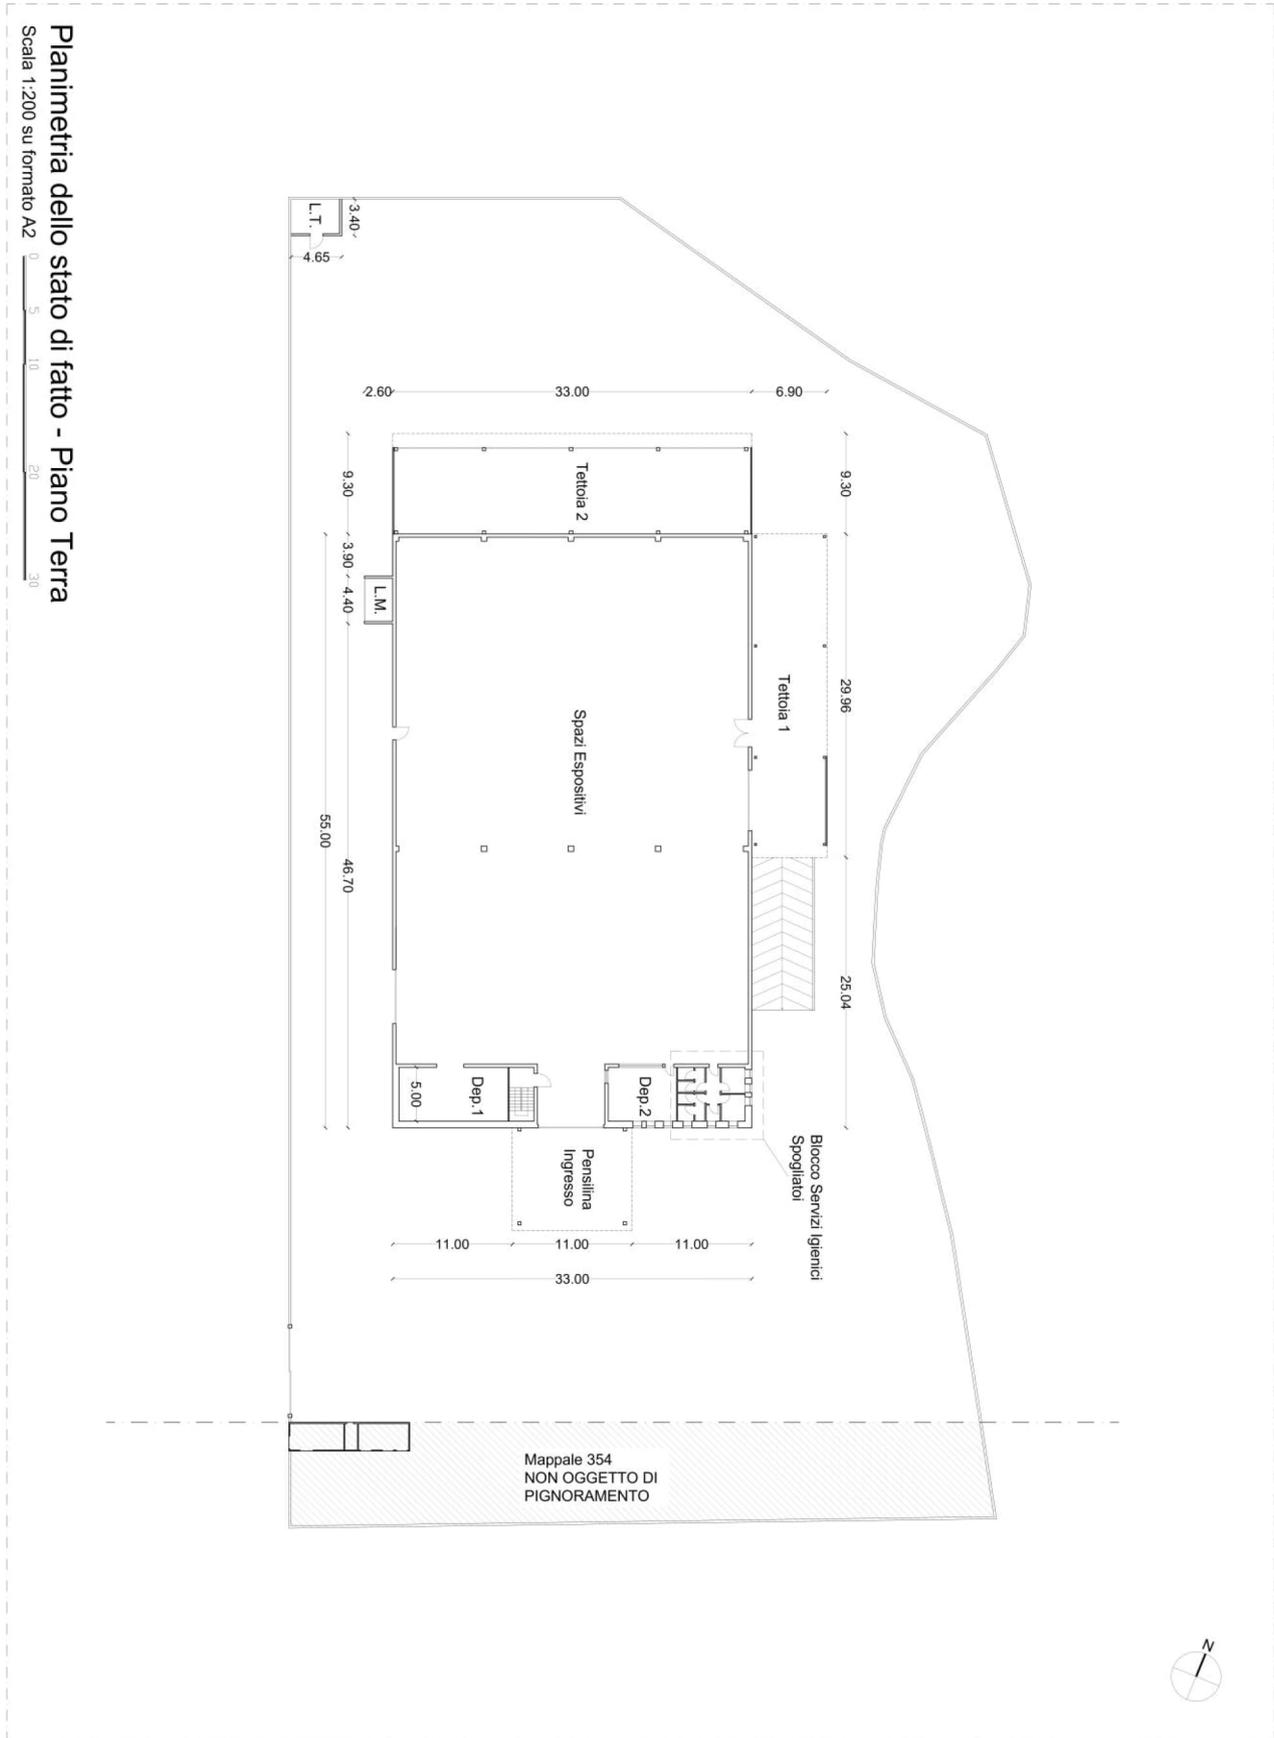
Planimetria dello stato di fatto – pianta piano terra
